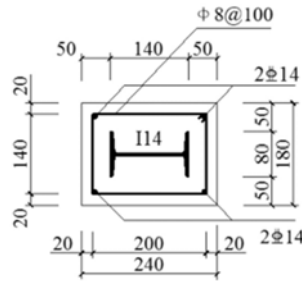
型钢混凝土短柱试件的几何尺寸及截面配筋图(单位: mm)
